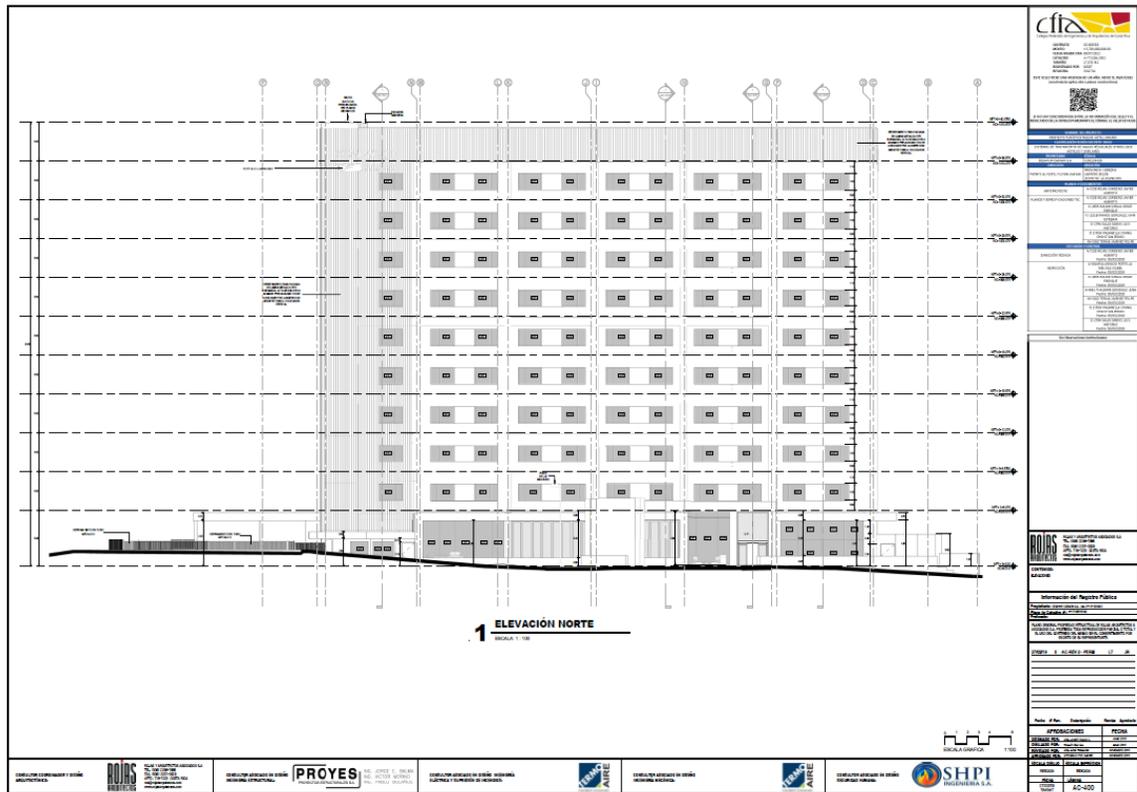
Elevación Lateral Norte. Proyección de Altura 40.00 metros sobre nivel de calle, lámina # AC-400 de los planos presentados.
